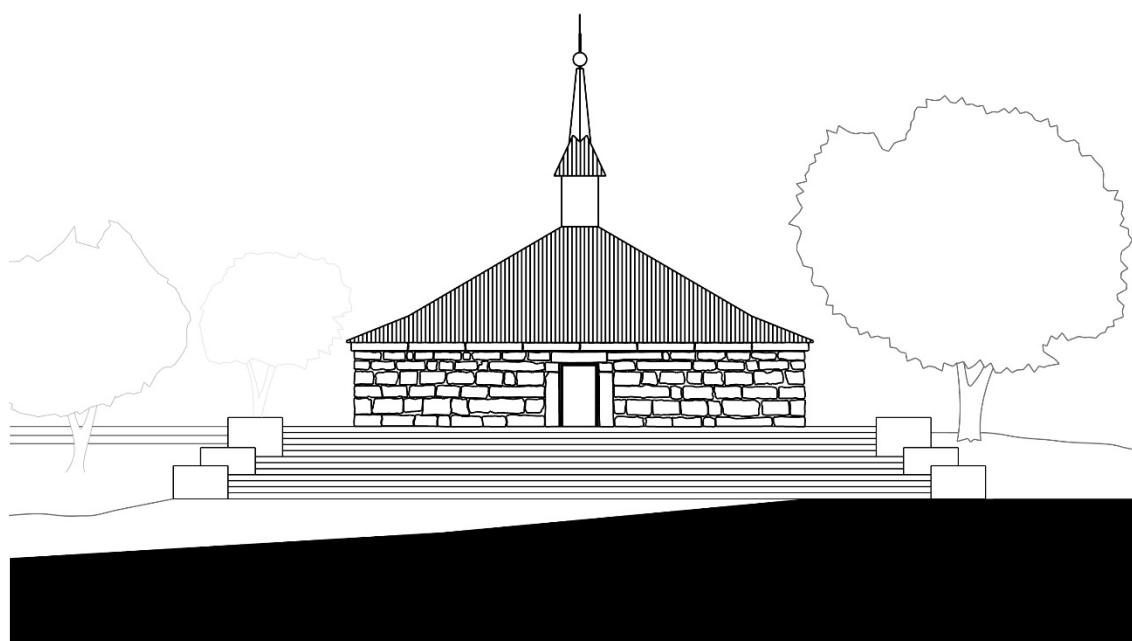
Planimetría con despiece del alzado norte del Real Nevero.
